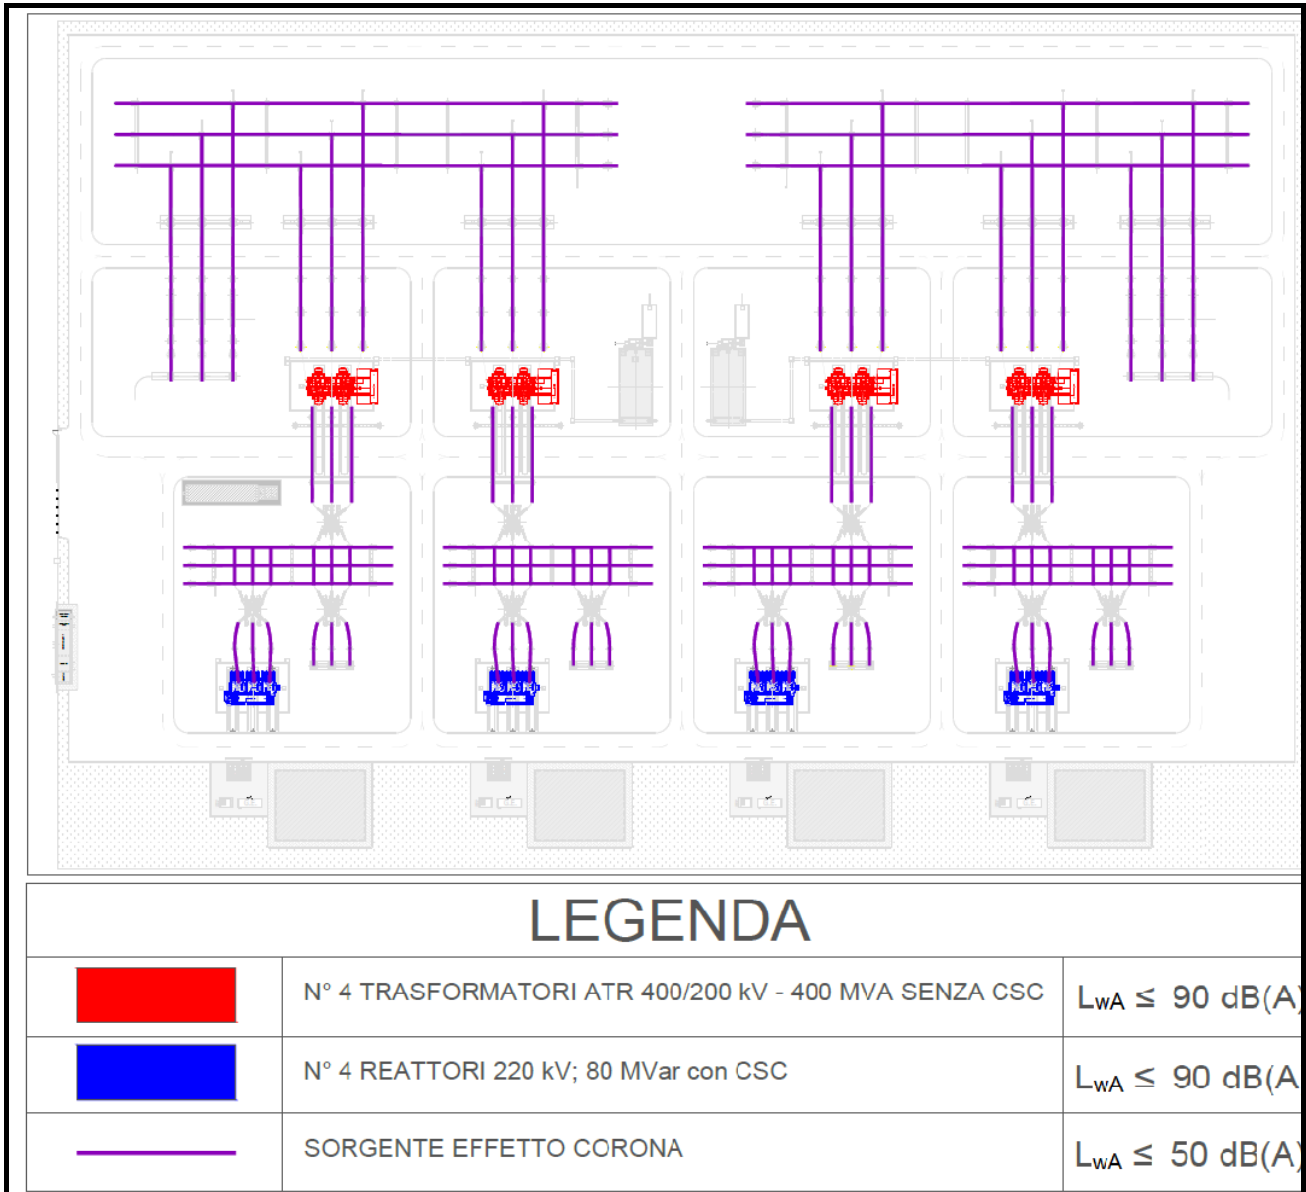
Layout Stazione Elettrica 220/380 kV "Lato Connessione" - ubicazione con sorgenti sonore.
